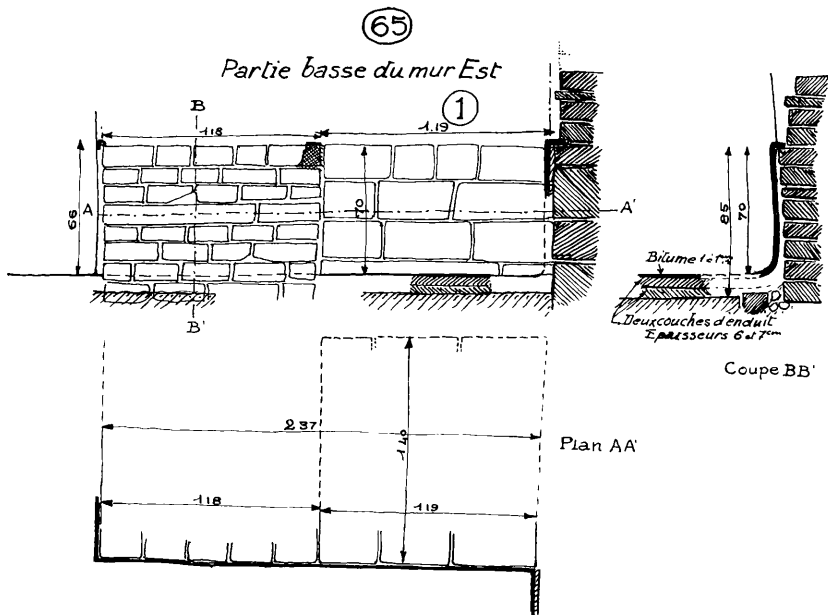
Salle du trône 65. Soubassements en pierre, mur est.
